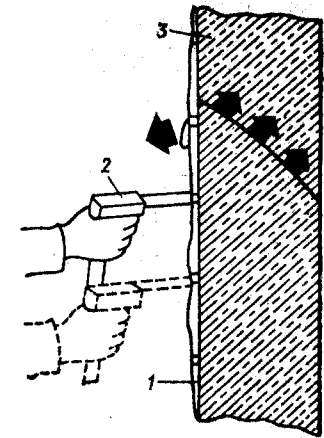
Ремонт трещин и неплотностей в бетонных и железобетонных конструкциях:
